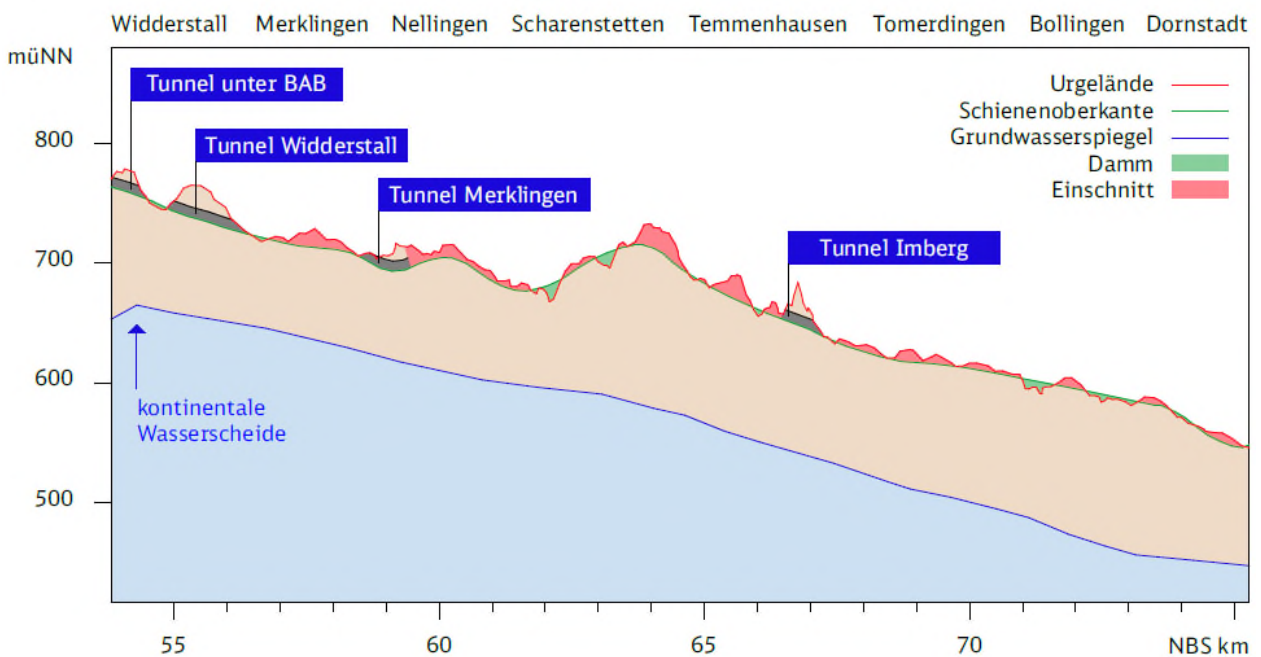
Höhenplan PFA 2.3 Albhochfläche mit Karstgrundwasserspiegel
